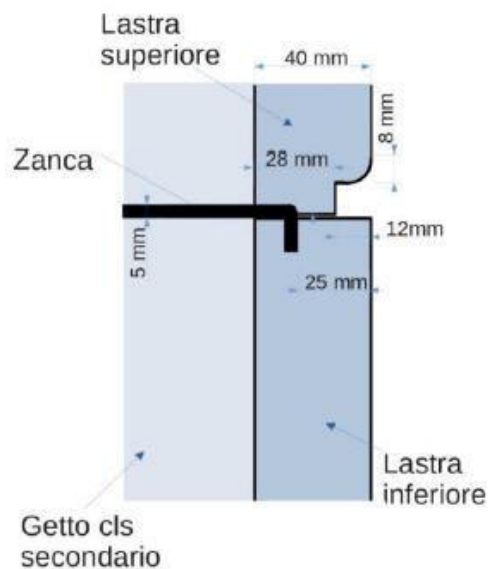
Dettaglio delle lastre e delle zanche di fissaggio
